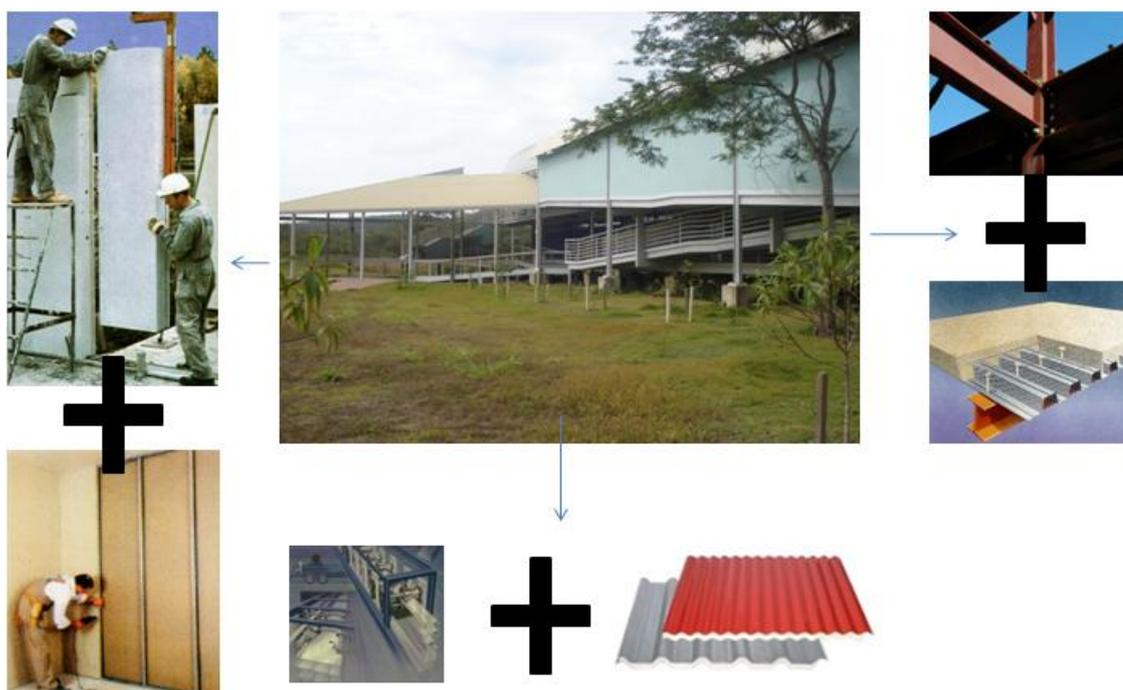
Sistemas construtivos originais do Edifício Piau
